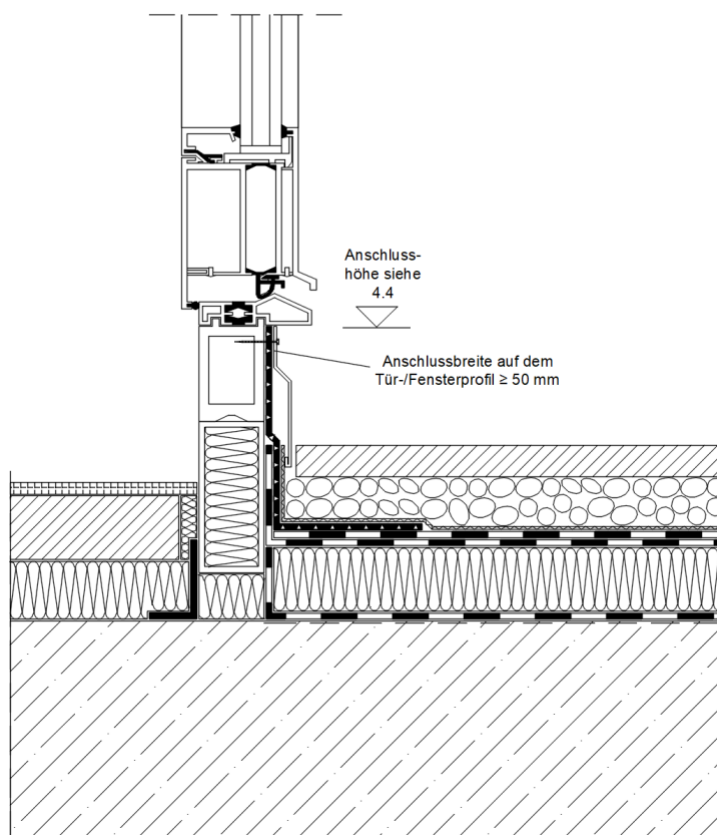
Terrassentüranschluss mit Entwässerungsrinne – Ausführung mit Bitumenbahnen, Flüssigkunststoff und Schutzblech – Anschlusshöhe  $\geq 5$  cm (durchgehende Deckenplatte)
